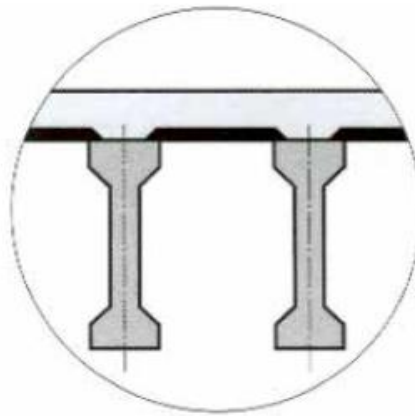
Coupe schématique d'un tablier à poutrelles précontraintes par pré-tension
